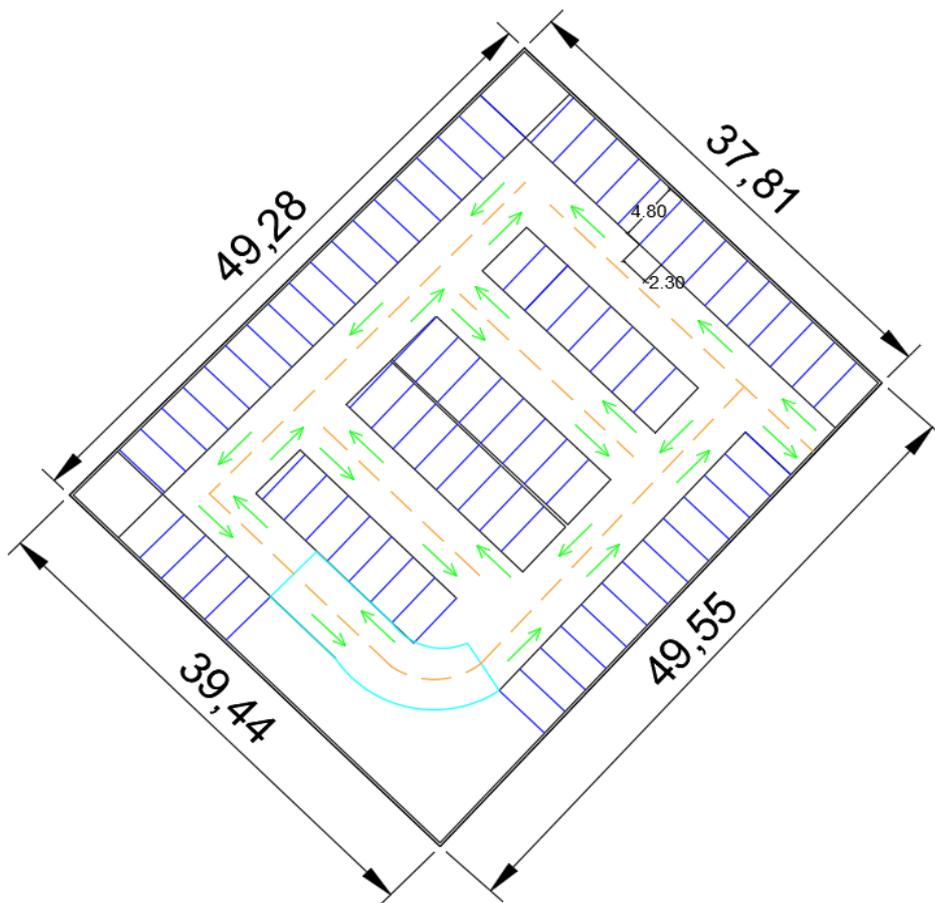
Vista en planta de edificio planteado para estacionamientos vehiculares
